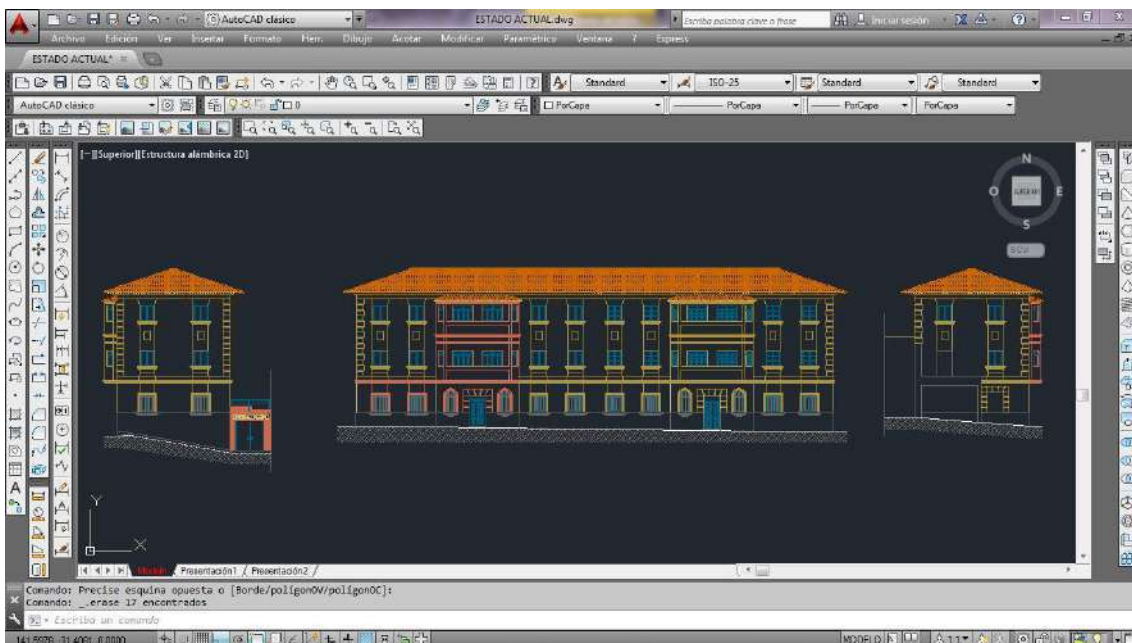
Levantamiento de las Fachadas en Autocad. 2016. Fuente propia.
